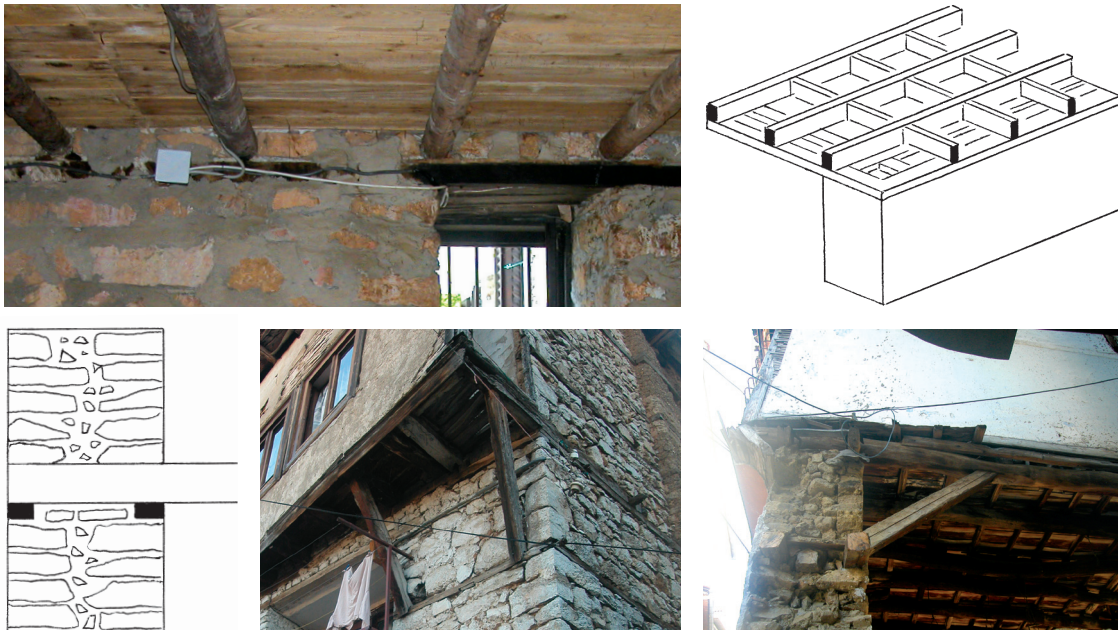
Liaison entre le mur porteur et le plancher : a) Solives fixées aux tasseaux de bois sous-jacents (Galitchnik) ; Schémas : Prolongement des entretoises au-delà des solives de rive (b) et section du mur au niveau du plancher (c) ; Jambes de force à l'extérieur (d, Ohrid) et à l'intérieur (e, Struga).
